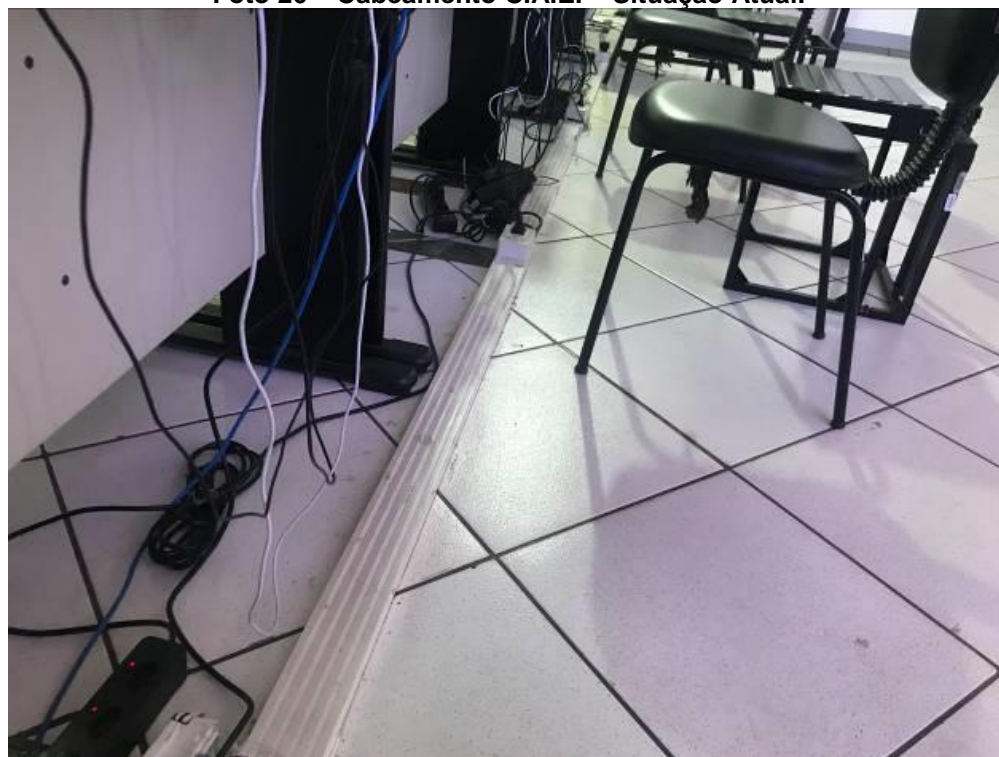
Cabeamento C.A.E.– Situação Atual.
